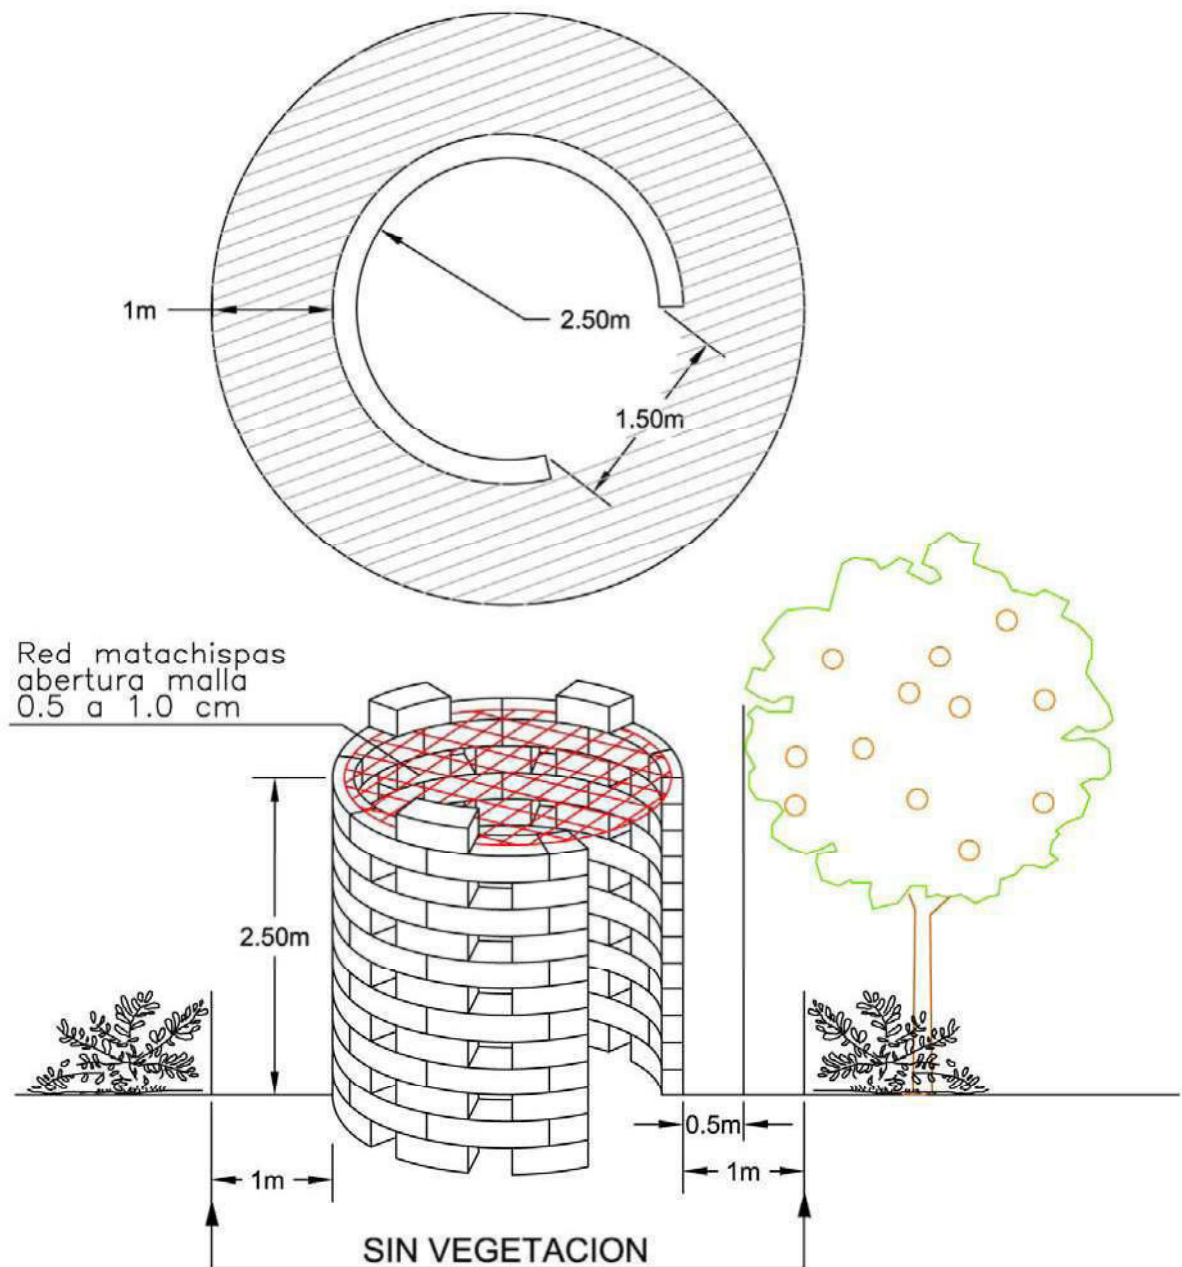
Planta y alzado de un quemador debidamente acondicionado.
